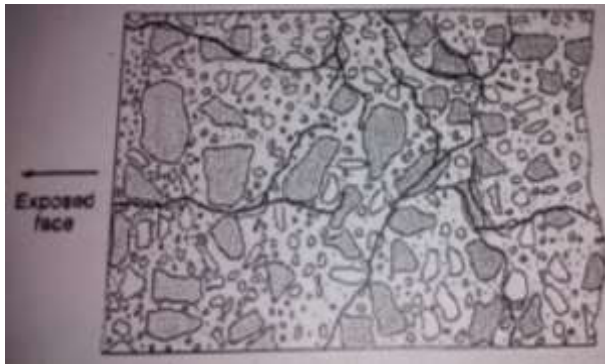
Grietas y fisuras en forma de mapa. Fuente
